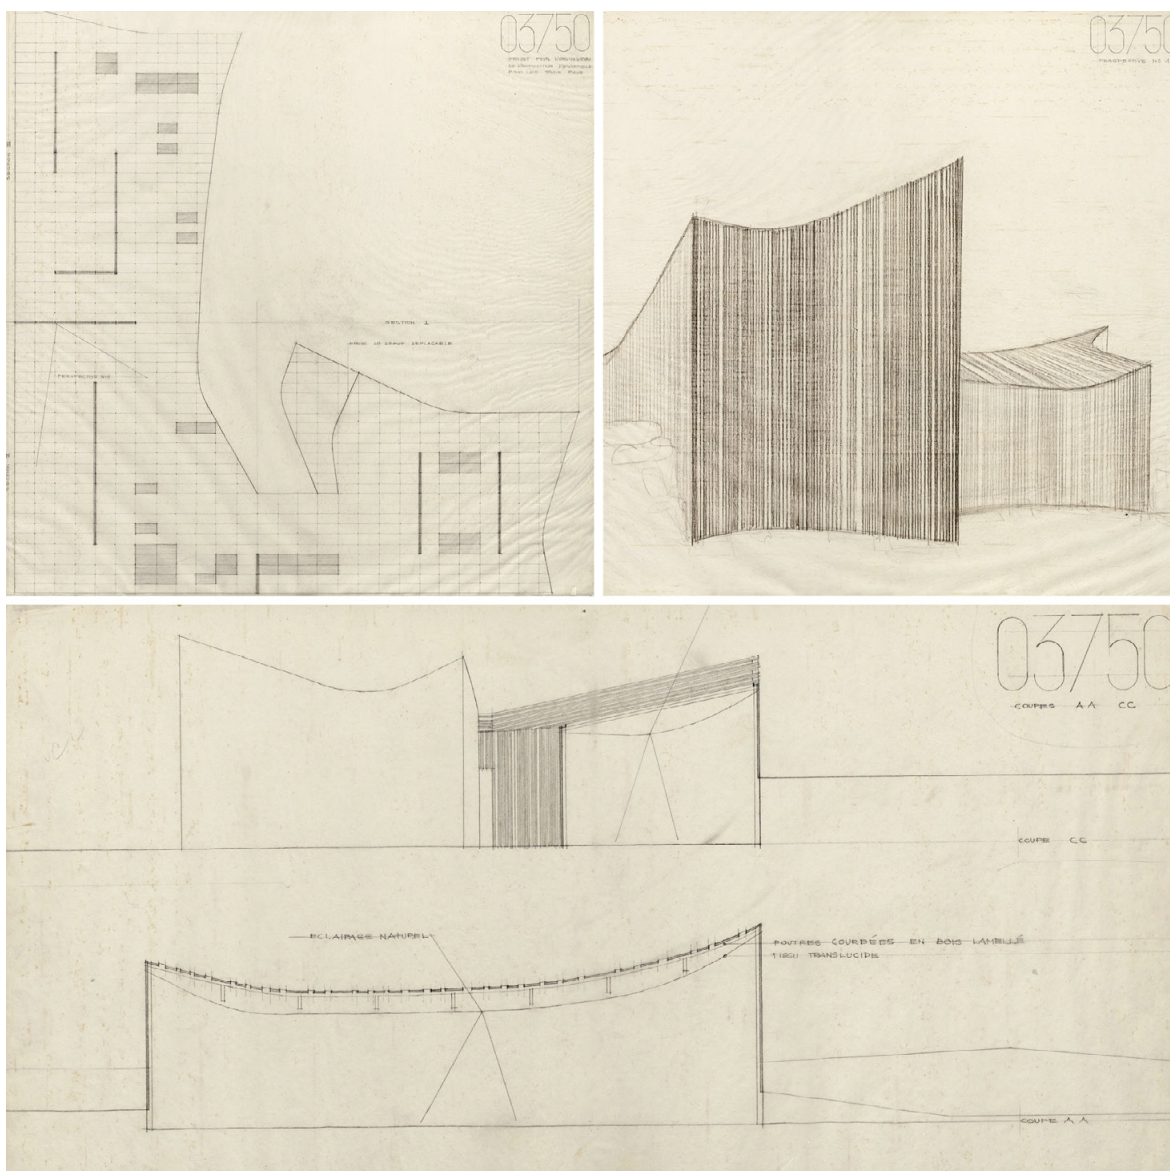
Planta, secciones y alzado de la propuesta 09. 1958, Reima Pietilä.
